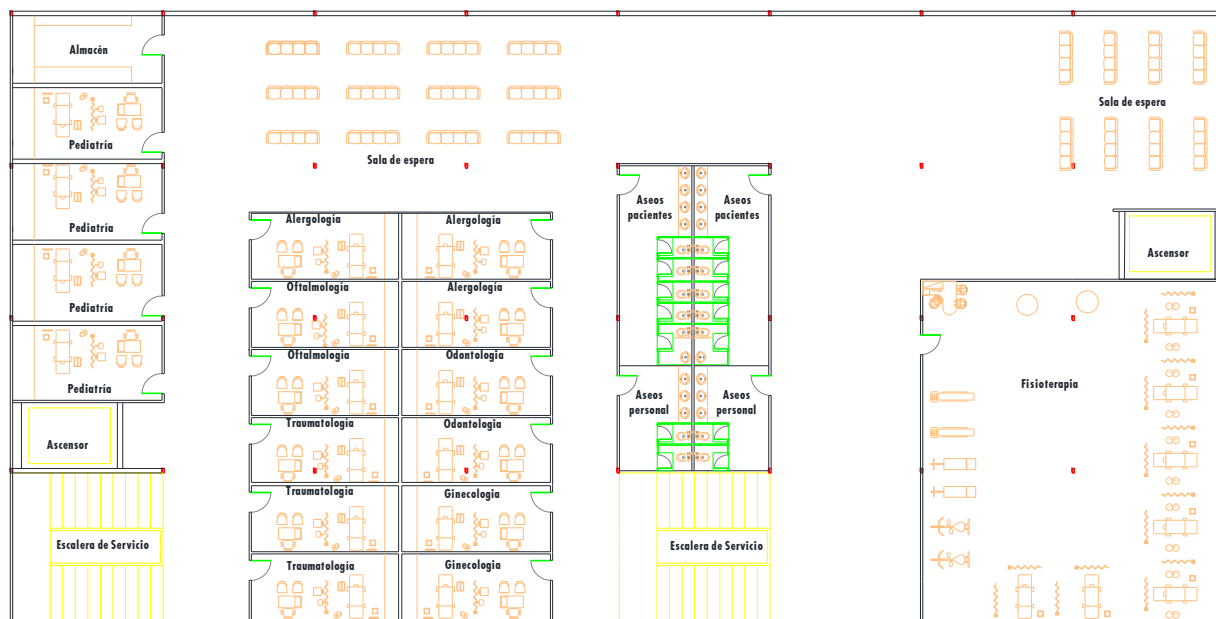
Primera planta. Fuente: AutoCAD (elaboración propia)
